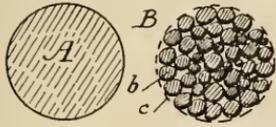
Coupe transversale d'un bois et d'une fascine.
